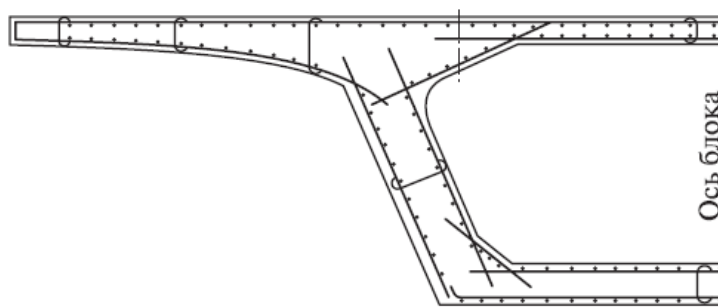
Армирование коробчатого поперечного сечения ненапрягаемой арматурой
